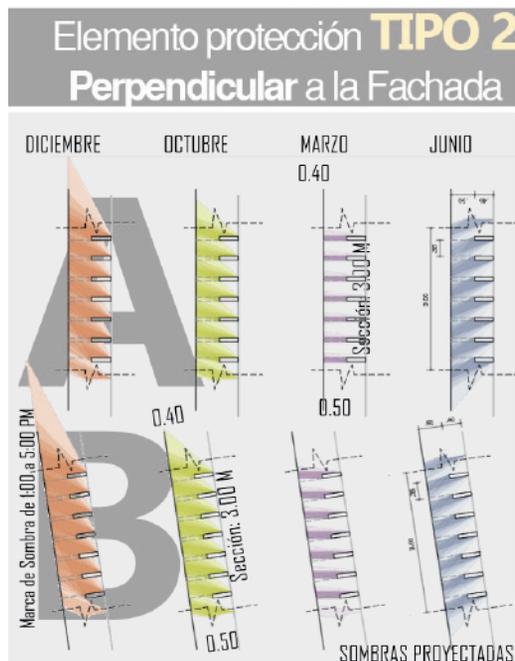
, Elemento Tipo 2 Naciente proyección sombras
